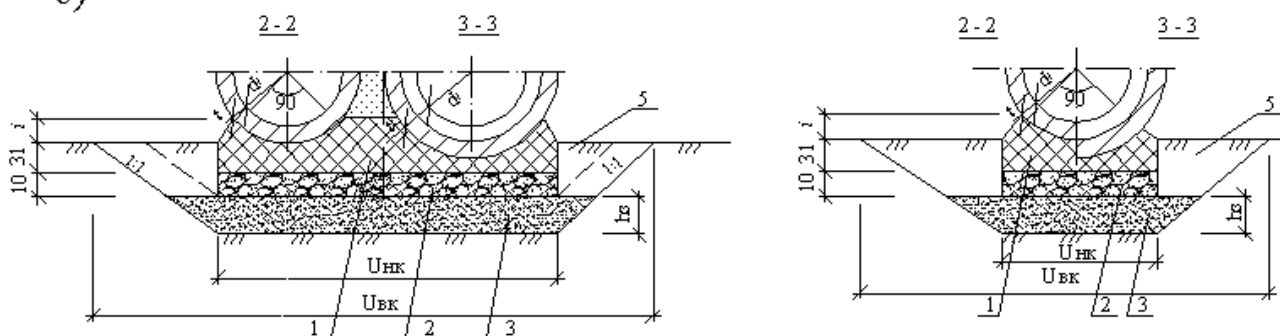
Поперечные разрезы: 2 – 2 и 3 – 3 (см. рис. 2.6.2 а) фундаментной трубы: а) без замены грунта основания; б) с заменой: 1 – бетон фундамента В25; 2 – щебень толщиной 10см; 3 – замена грунта основания; 4 – заполнение пазух двухочковой трубы бетоном В7,5; 5 – обратная засыпка котлована
